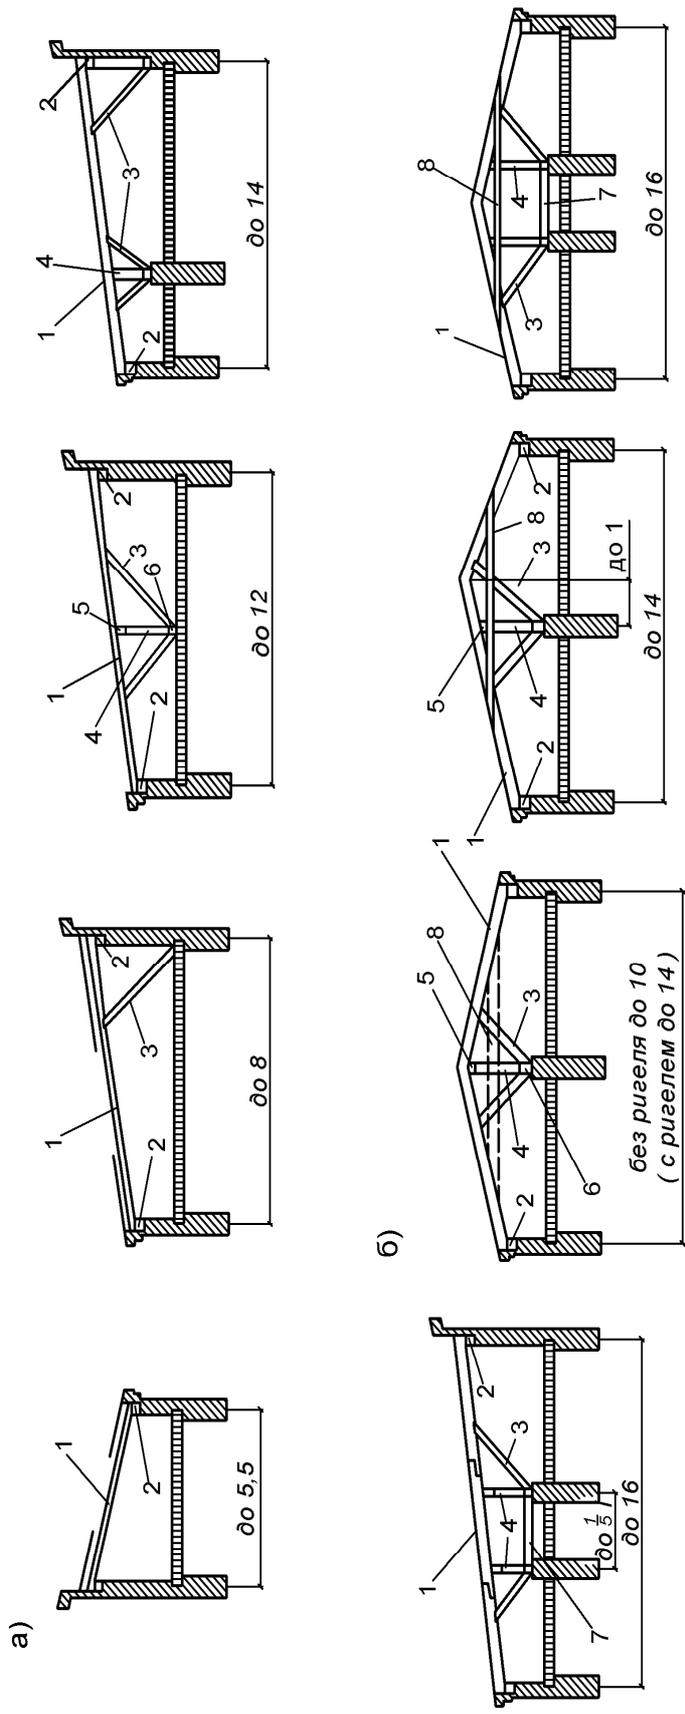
Конструктивные схемы крыши из деревянных наслонных стропил (размеры даны в мм): а – для односкатных крыш; б – для двускатных крыш: 1 – стропильная нога; 2 – мауэрлат; 3 – подкос; 4 – стойка; 5 – верхний прогон; 6 – лежень; 7 – распорка; 8 – ригель
